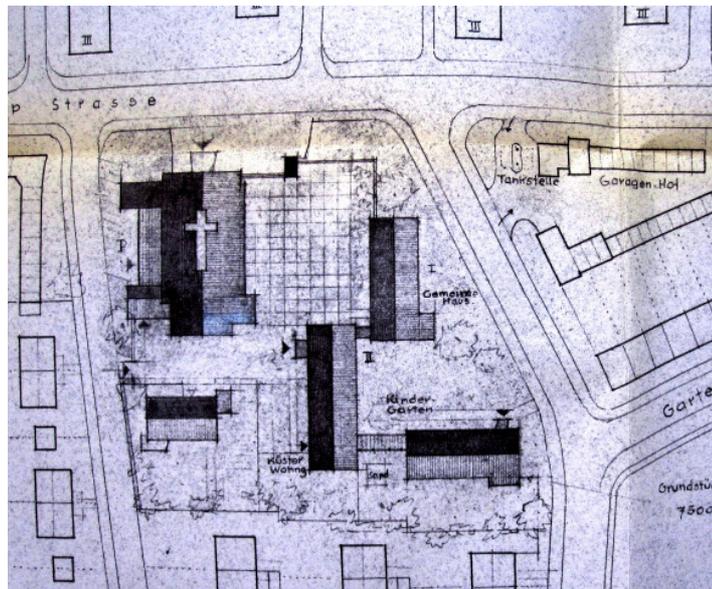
Vorentwurf für den Neubau. Plan 1, Lageplan (Ausschnitt), O. Hodler, undatiert
